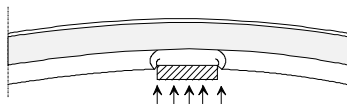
Zusätzliche Untersuchungen bei Sandwichbauteilen mit einer profilierten Deckschicht.
